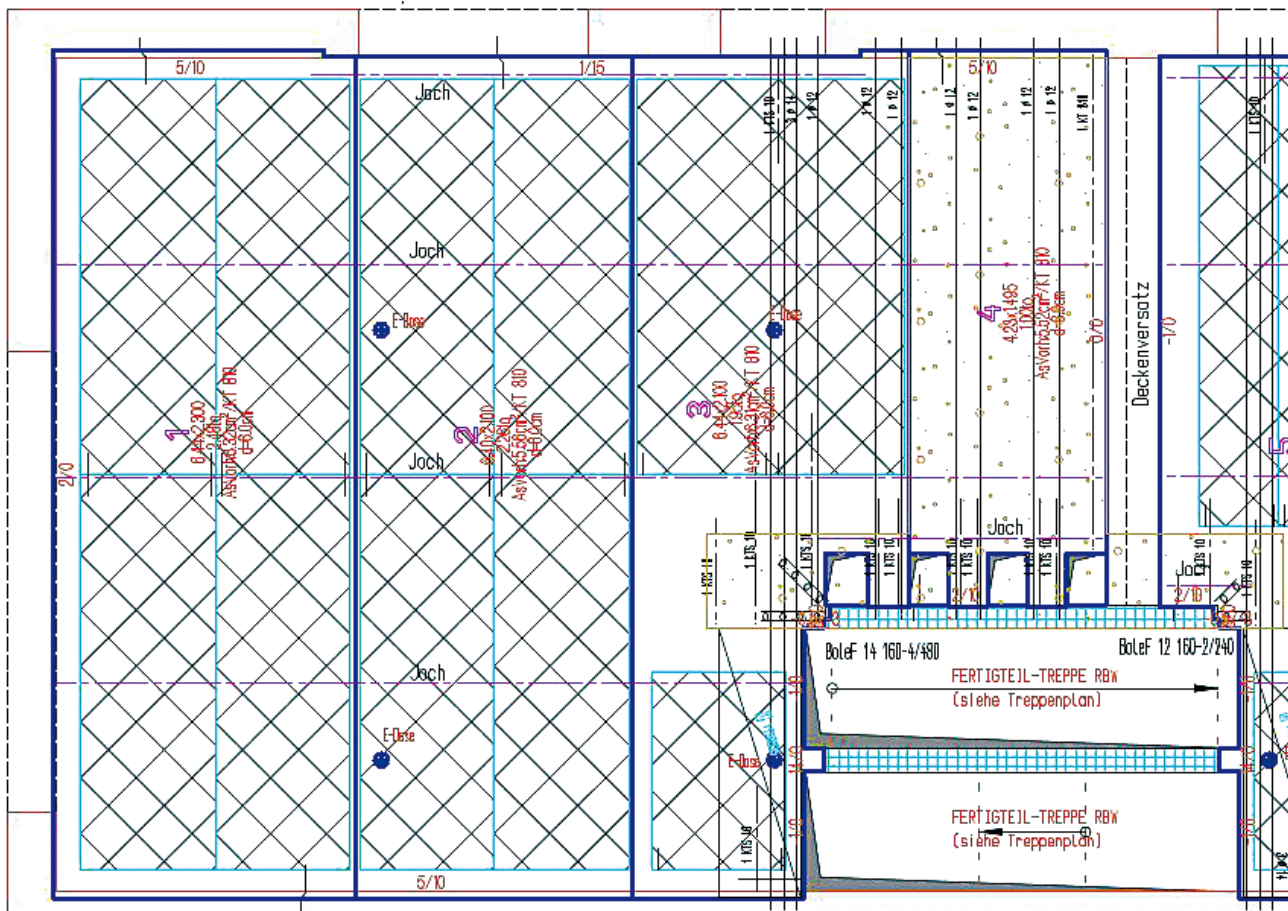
Фрагмент обзорного чертежа сборно-монолитного перекрытия с модулями трубопроводов в жилищном строительстве
